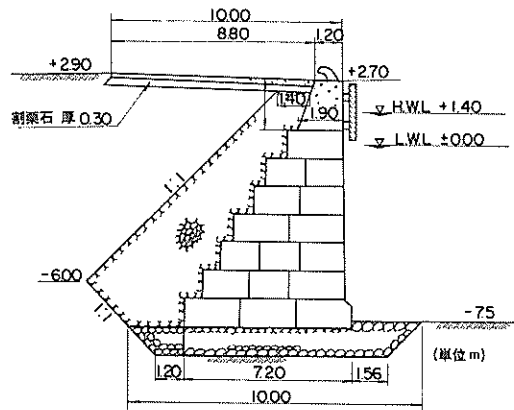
女川港石浜地区 - 7.5 m 岸壁標準断面図
